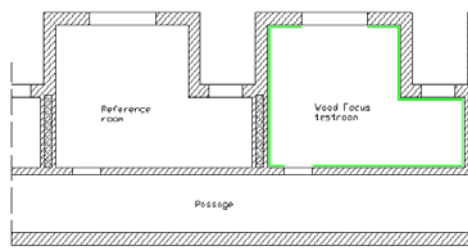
Grundriss der beiden Versuchsräume.
